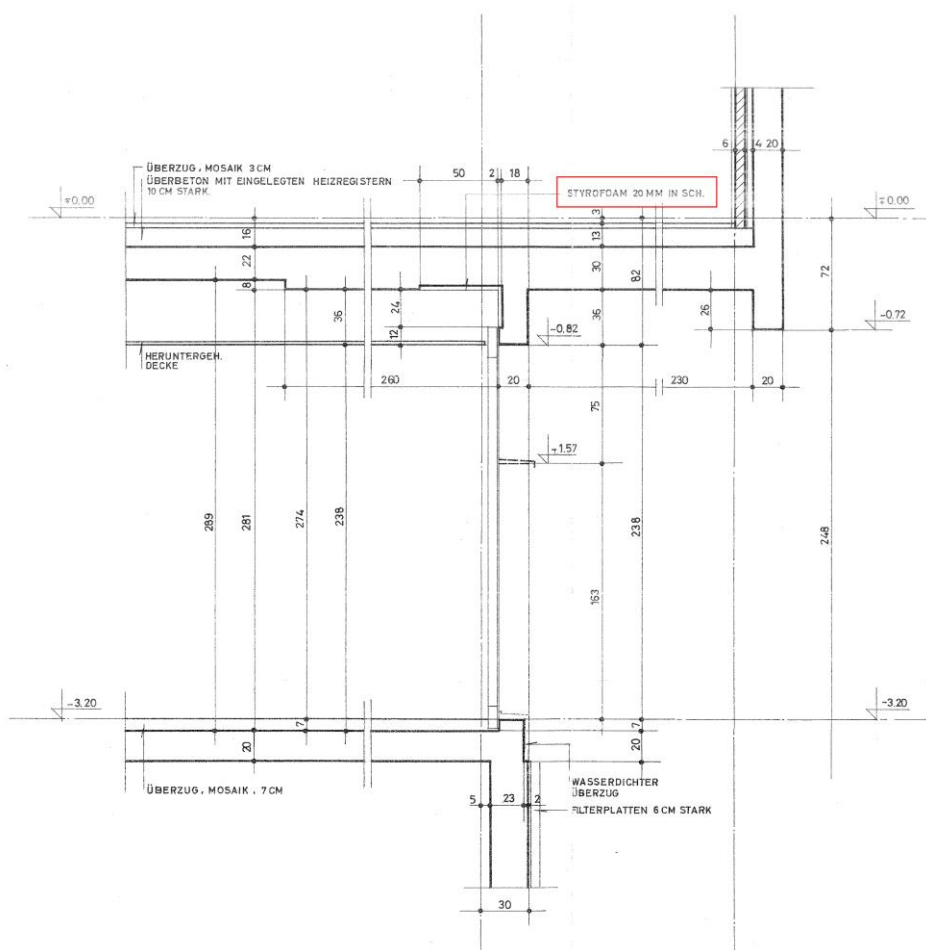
Schnitt durch Fassade mit eingelegter Styrofoamdämmung (Schnitt 66 aus Plan 147/99)
